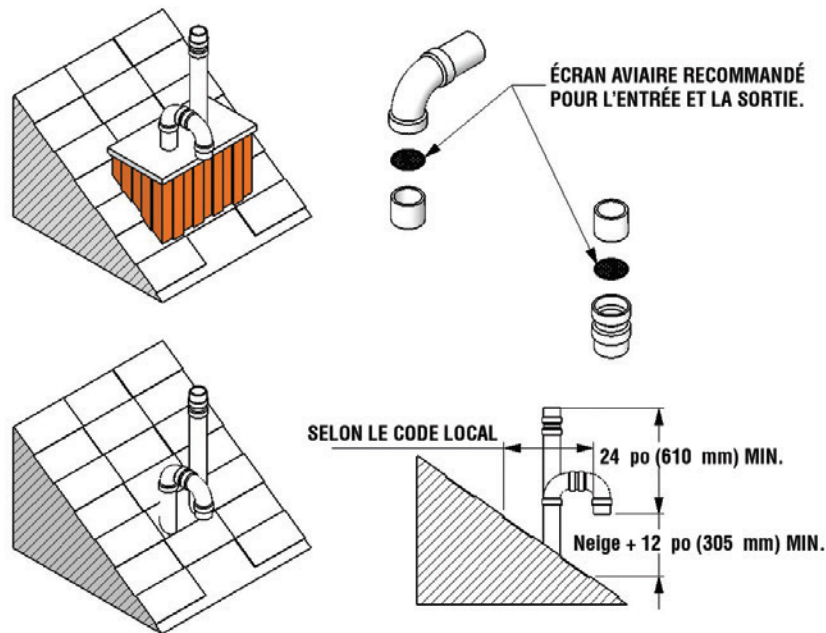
Ventilation à travers le toit. Configuration de l'extrémité des conduits.
